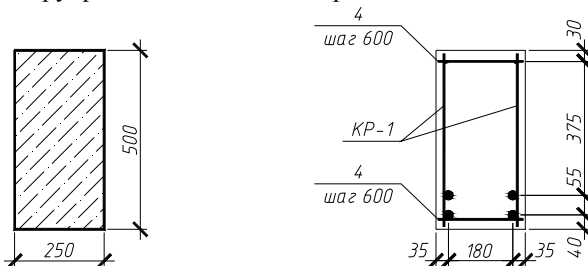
Конструирование элемента (к примеру расчета 2).
